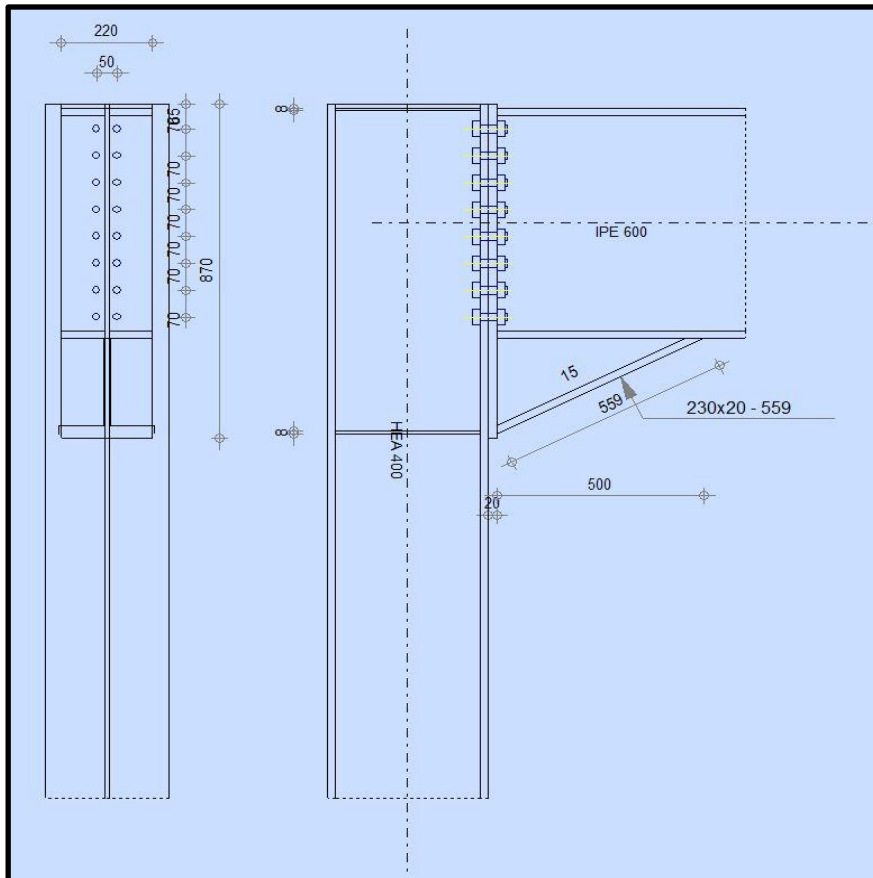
Schéma d'assemblage poteau HEA 400 – poutre IPE 600
